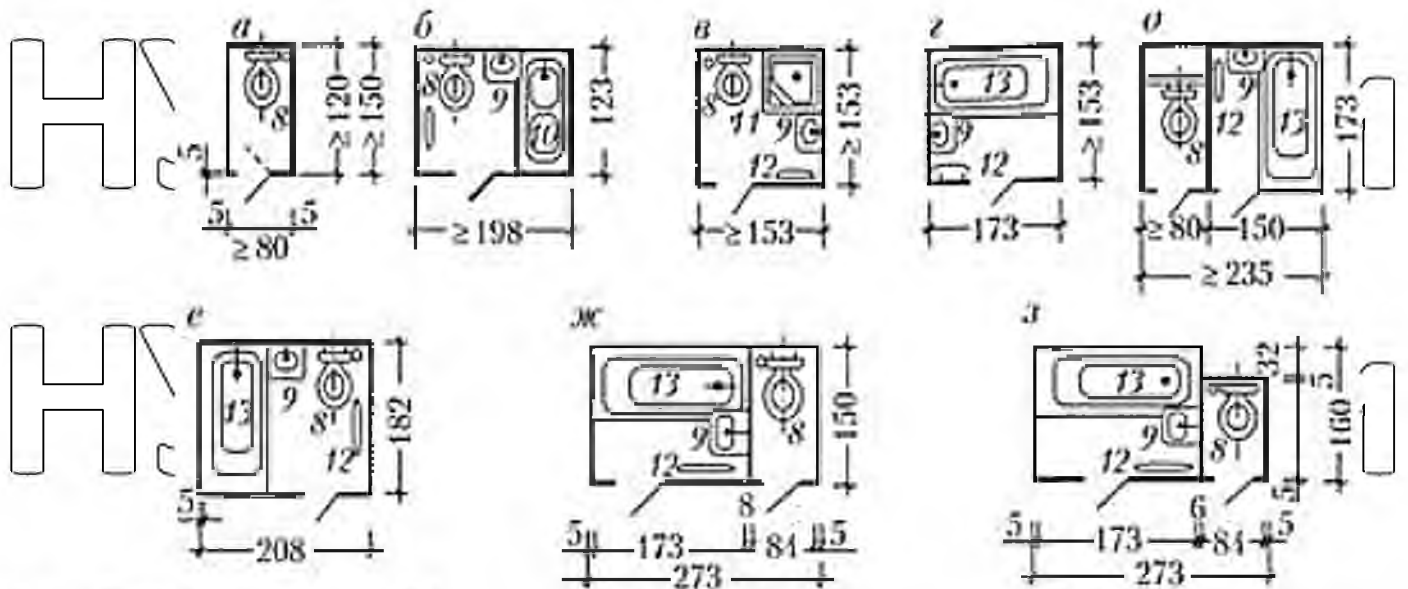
Модуль типових планувальних рішень санітарних вузлів в квартирах: *а* - туалет; *б* - суміщений санвузол з сидячою ванною; *в* - суміщений санвузол з душем; *з* - ванна (ванна кімната); *о* - роздільний санвузол; *е* - з - санвузол з об'ємних блоків заводського виготовлення
